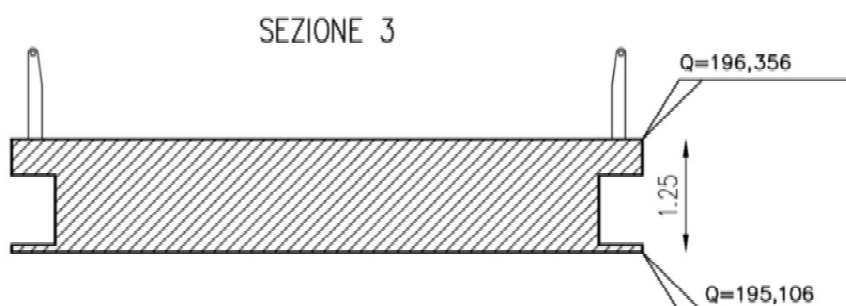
Rilievo Piacentini Ingegneri, sezione trasversale 3 sulla campata lato Pianoro
